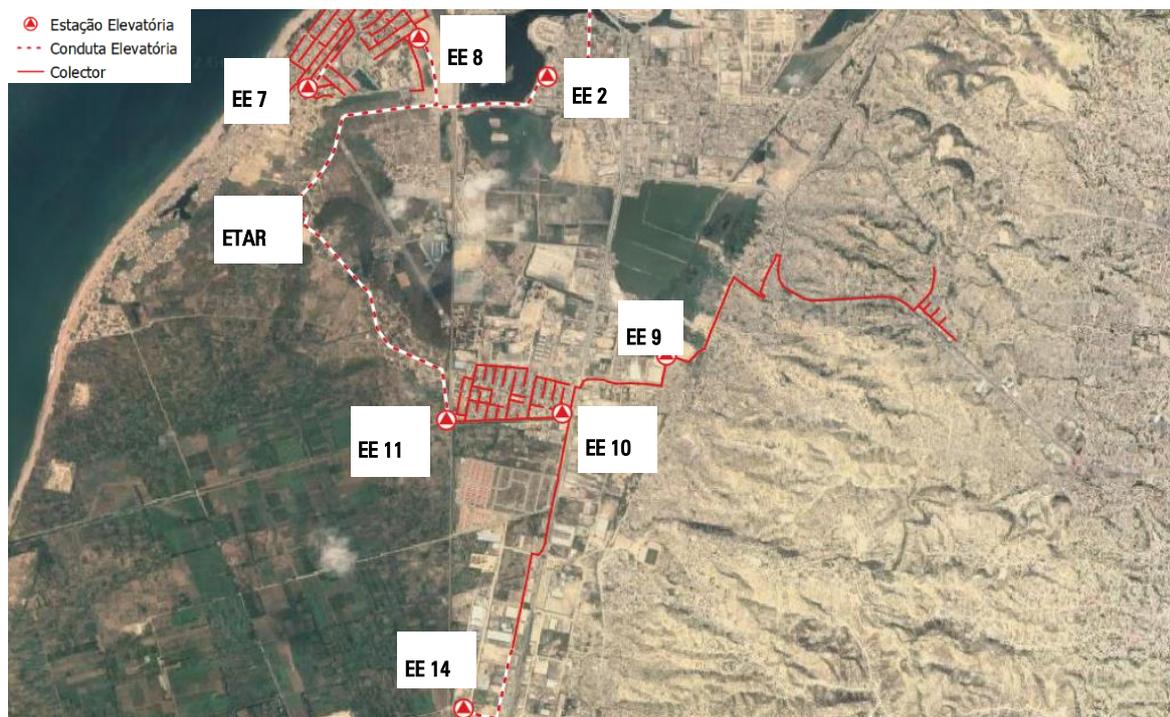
Representação esquemática das infra-estruturas de drenagem previstas. Bairro da Luz, Zona Alta e PDIC (Planta 2/3)
